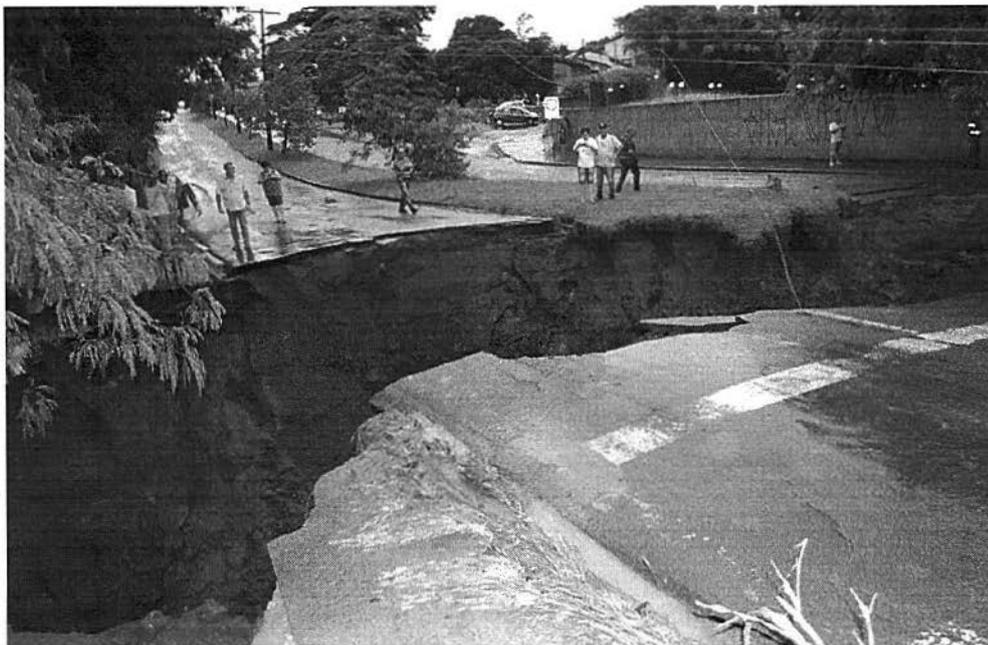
Vista lateral da ruptura da travessia da Avenida Otto Ribeiro
